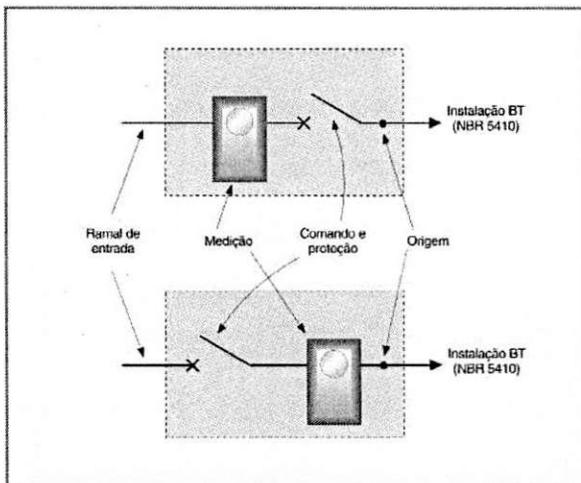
Origem de instalação alimentada diretamente em baixa tensão
